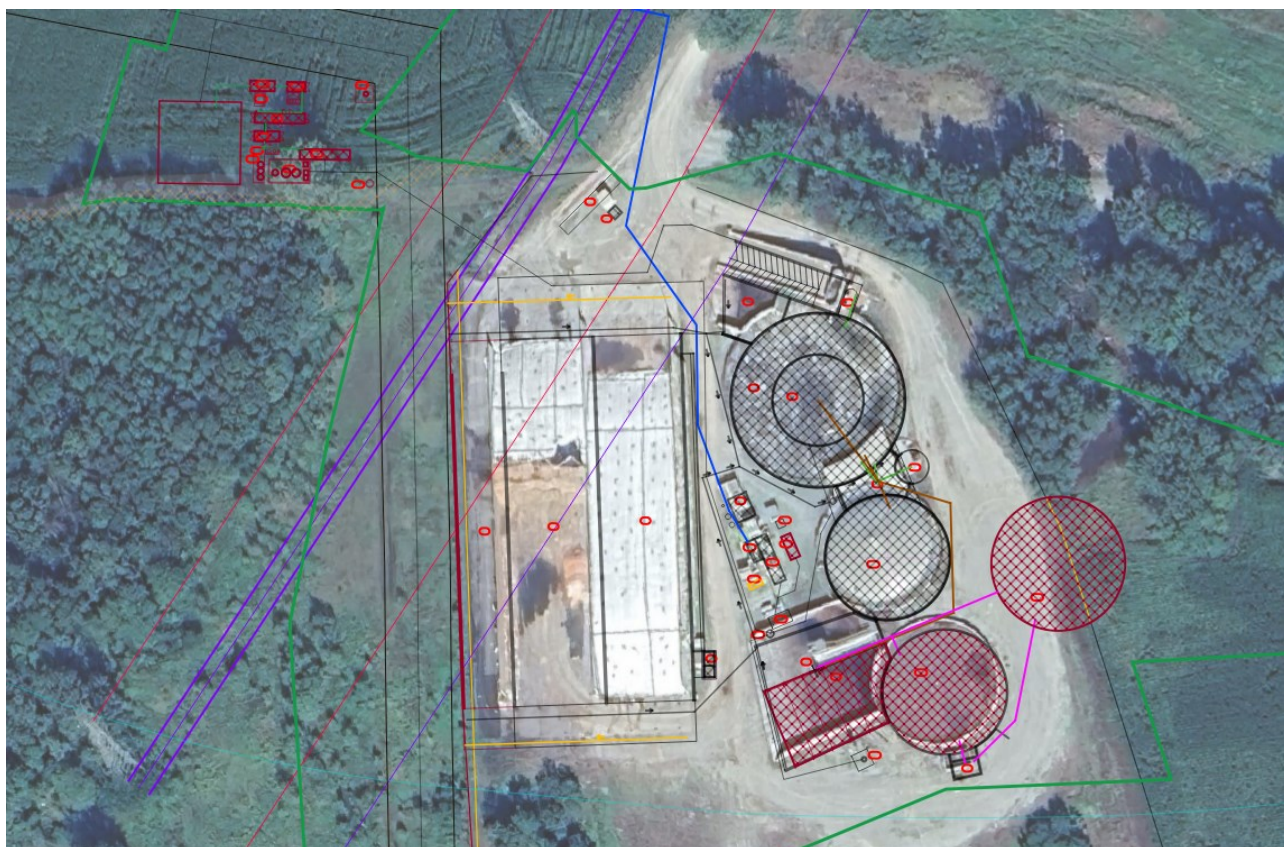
Configurazione dell'impianto nella condizione di progetto
